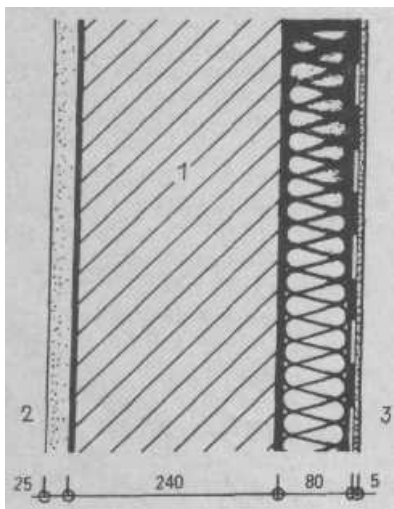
Стена с внутренней полистирольной теплоизоляцией и паронепроницаемым слоем. Швы перекрыты алюминиевой лентой
